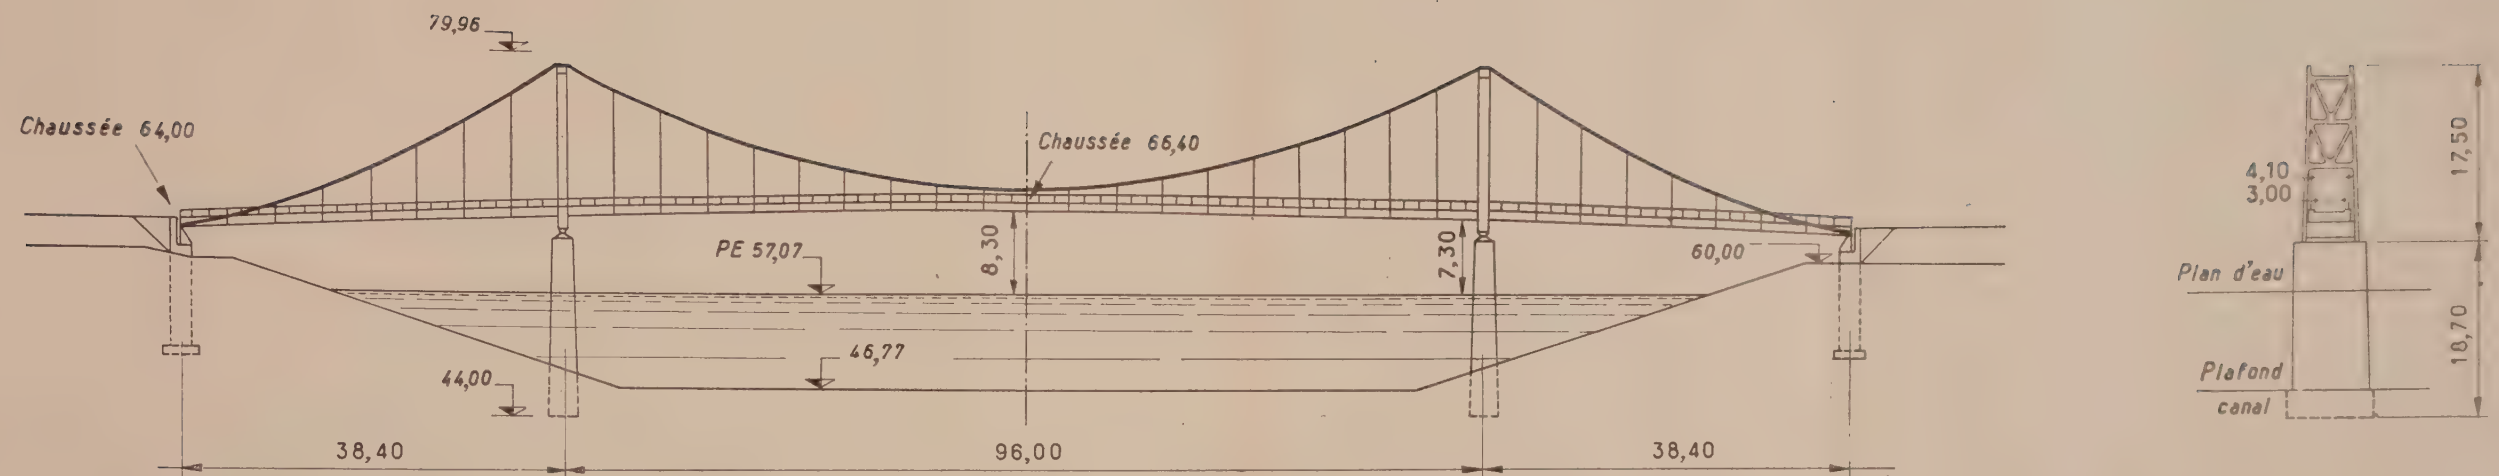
Pont du V. O. 2. Élévation et coupe transversale.
